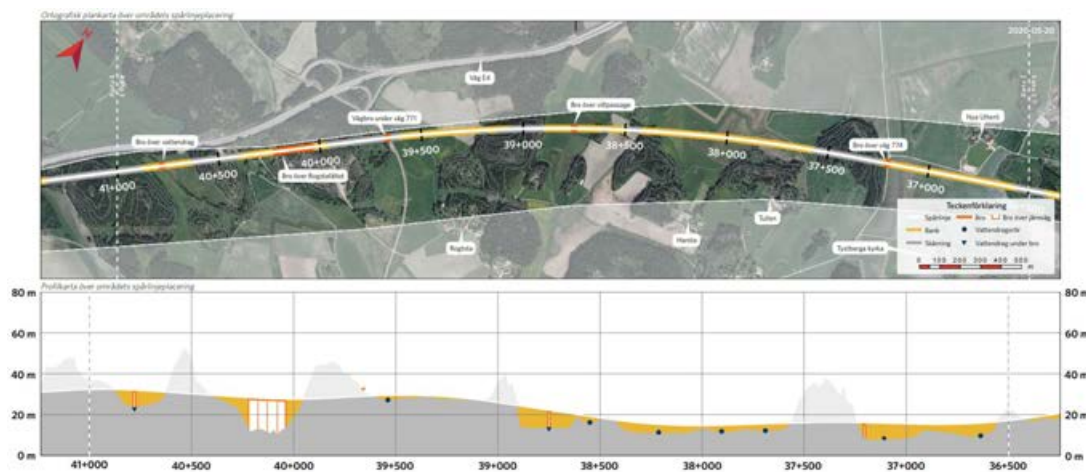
Järnvägens sträckning i plan och profil mellan Sillekrog och Gärdesta.
